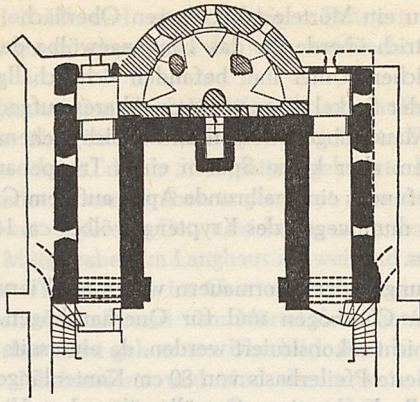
Abb. B Meschede, ehem. Stiftskirche St. Walburga. Grundriß der Krypta.
